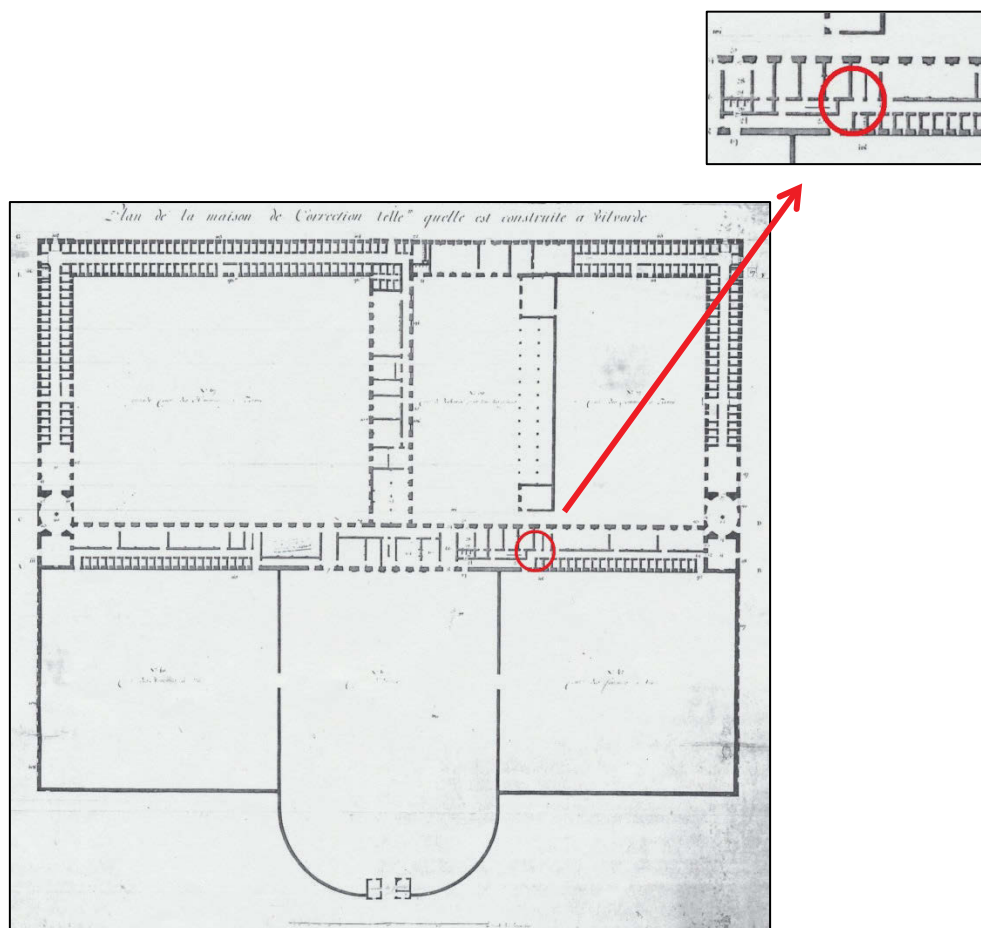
De situering van de geregistreerde funderingen op het plan van Dewez uit 1773.
